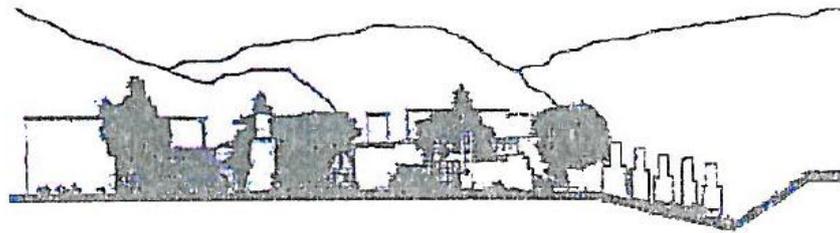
Corte esquemático y elevación de la quebrada de Supay-Huayco. Fuente: Propuesta de Declaratoria del Cementerio Municipal De Cuenca. 2002
